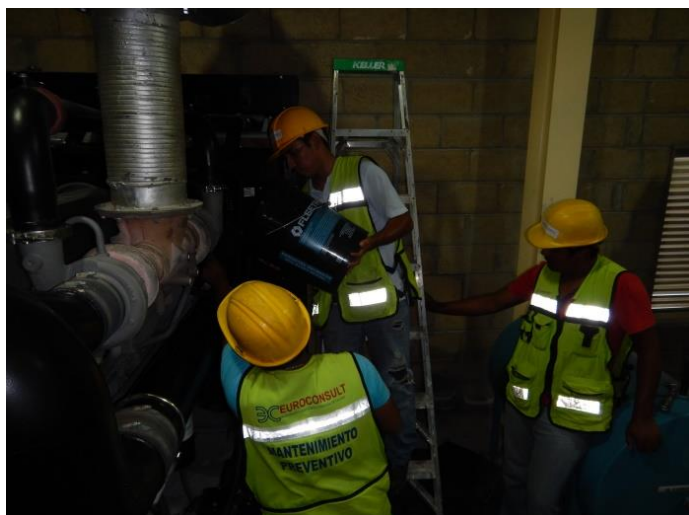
Realización de afinación a la planta de apoyo de ventilación del cuarto de máquinas El varal
